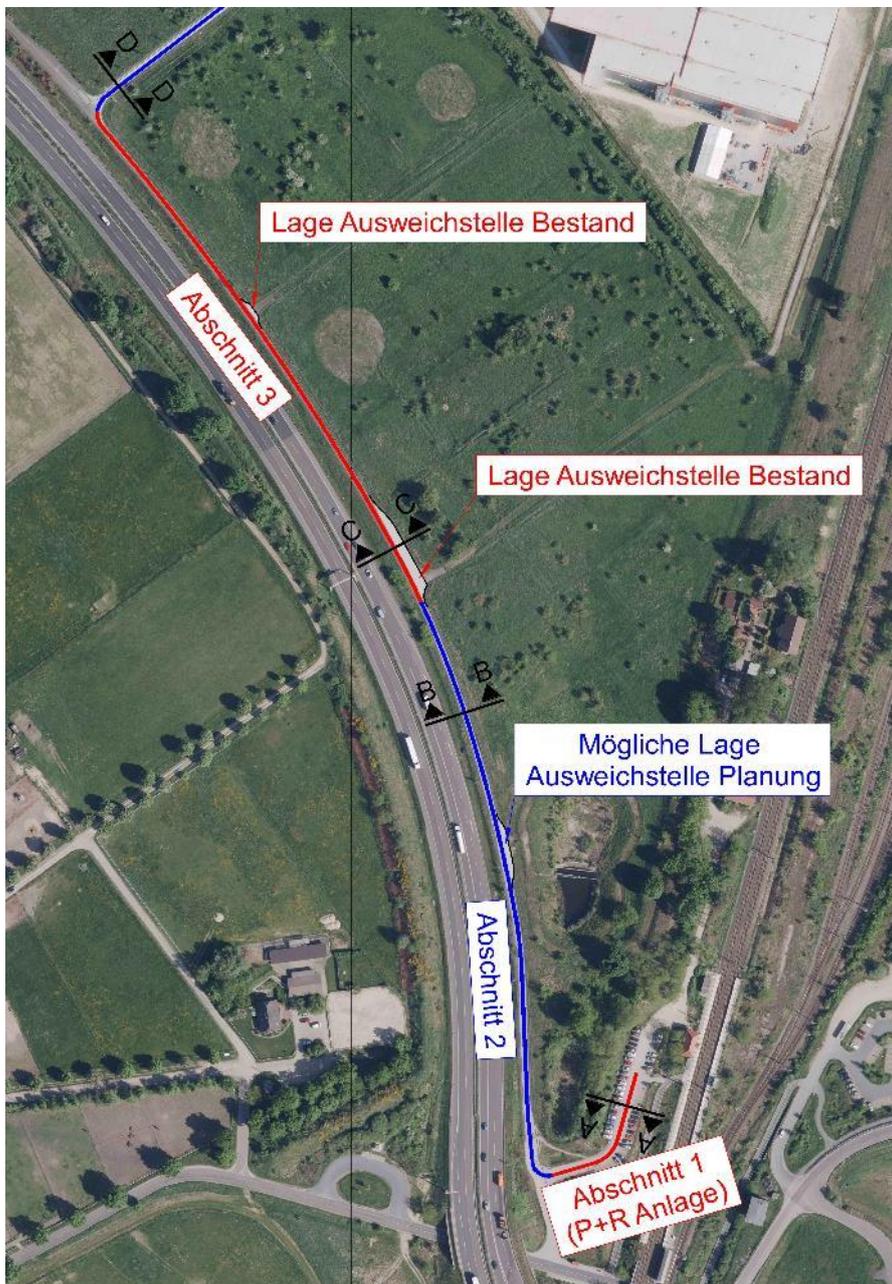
Ausschnitt Übersichtslageplan Stufe 1
